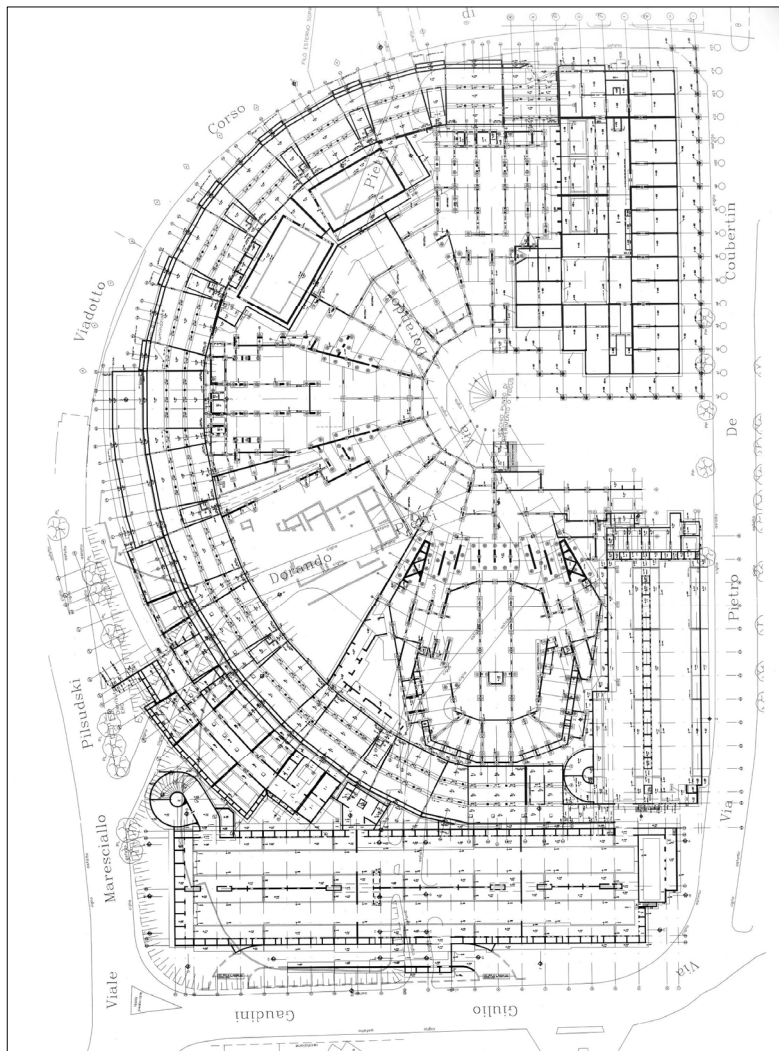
Planimetria generale delle strutture di fondazione
